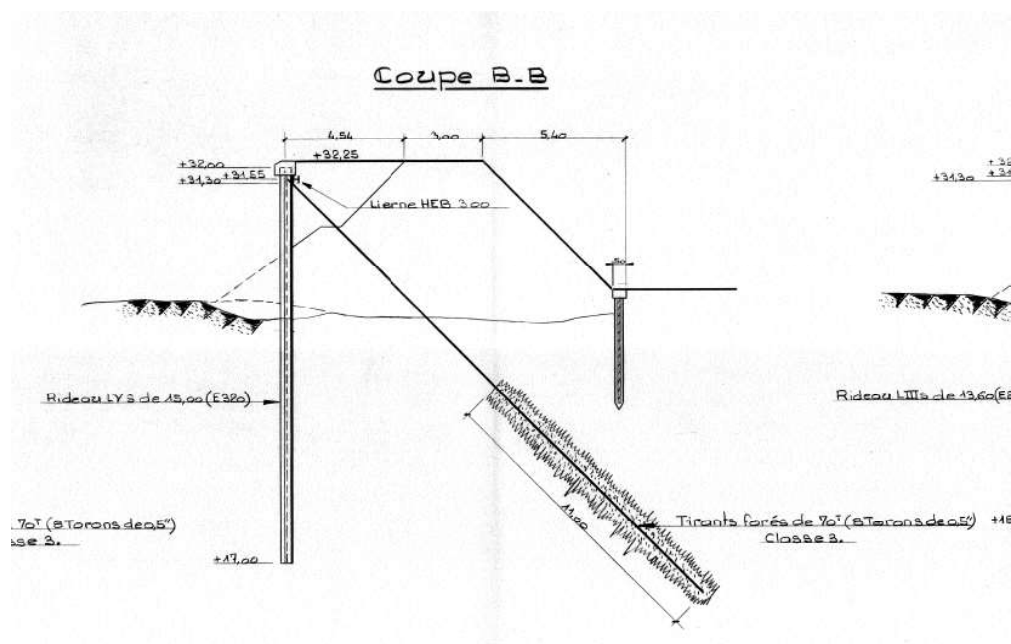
Coupe type associée au rideau tirant - zone barrage (Archives VNF)
